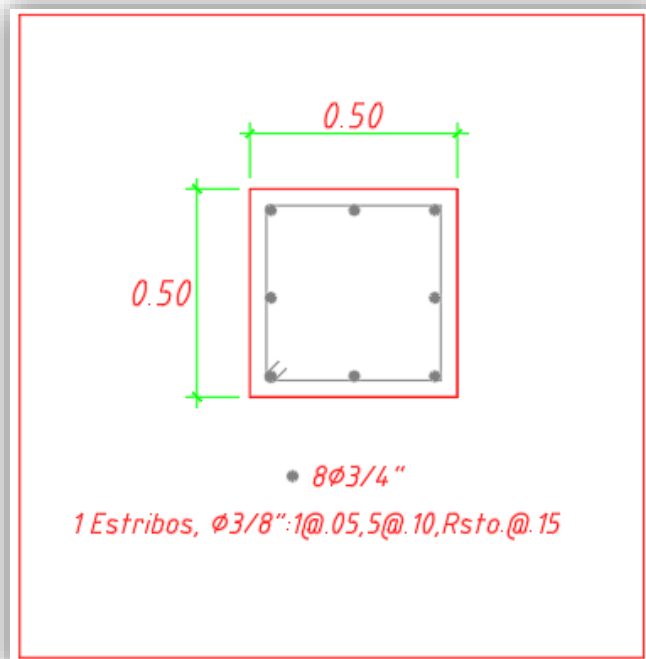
Detalle de refuerzo en columna C3 piso 6 y 7
